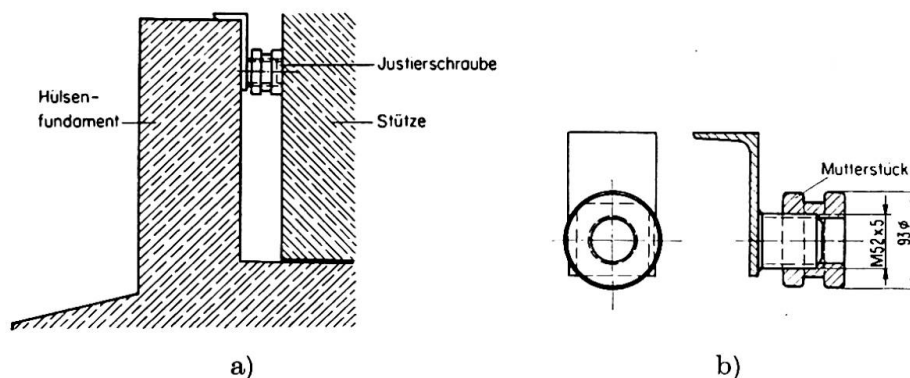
a) Justieren schwerer Stützen mittels Justierschrauben [3].
